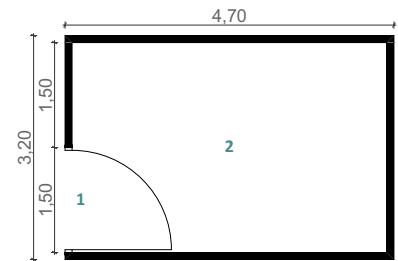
Planta cuarto de máquinas. Fuente: Autores.
